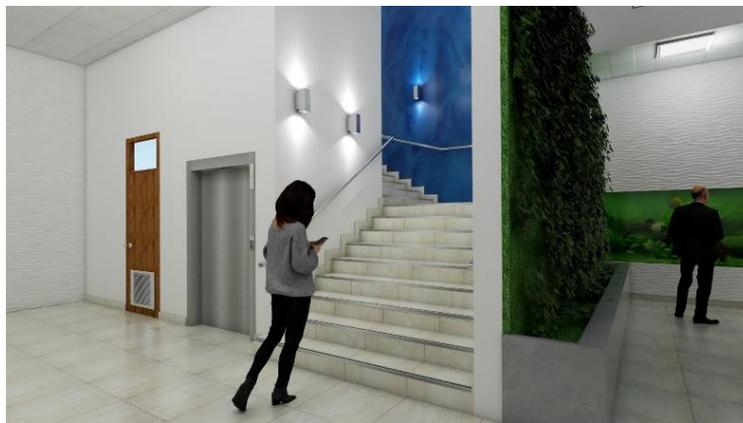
Vista de la escalera y ascensor en 1° piso
